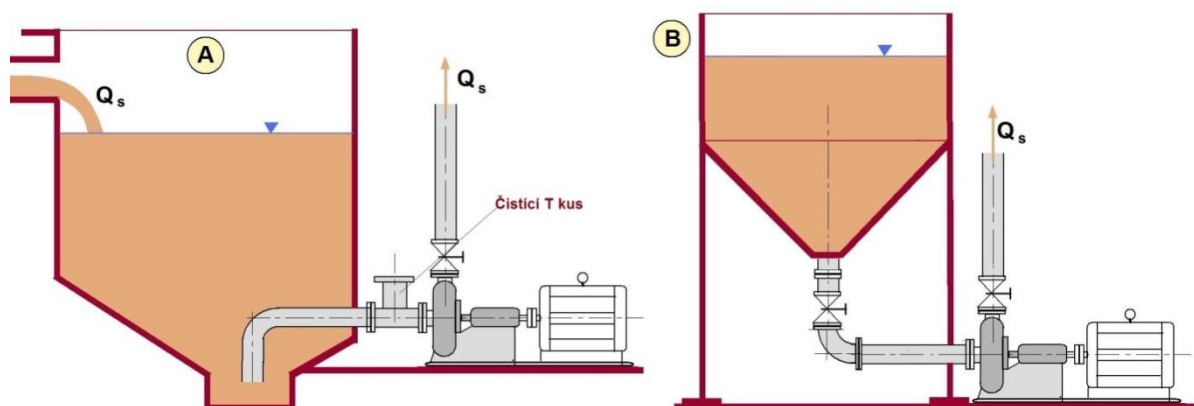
Průchod sacího potrubí přes betonovou stěnu sací jímky
